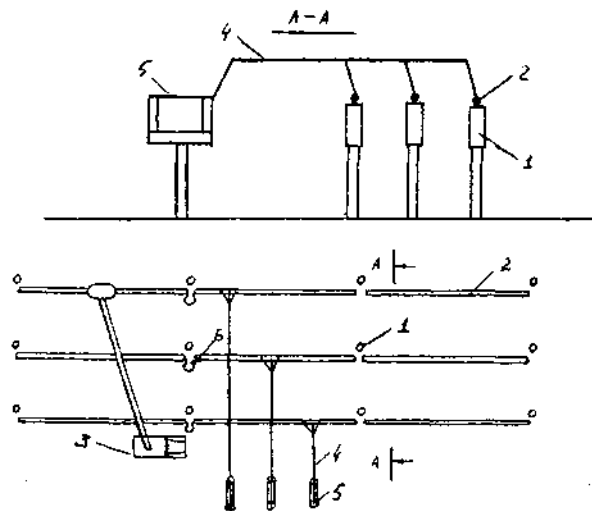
Схема монтажа жесткой ошиновки: 1 — опорные изоляторы; 2 — сборные шины; 3 — передвижная вышка типа АГП-12; 4 — ответвление; 5 — разъединитель; 6 — компенсатор
